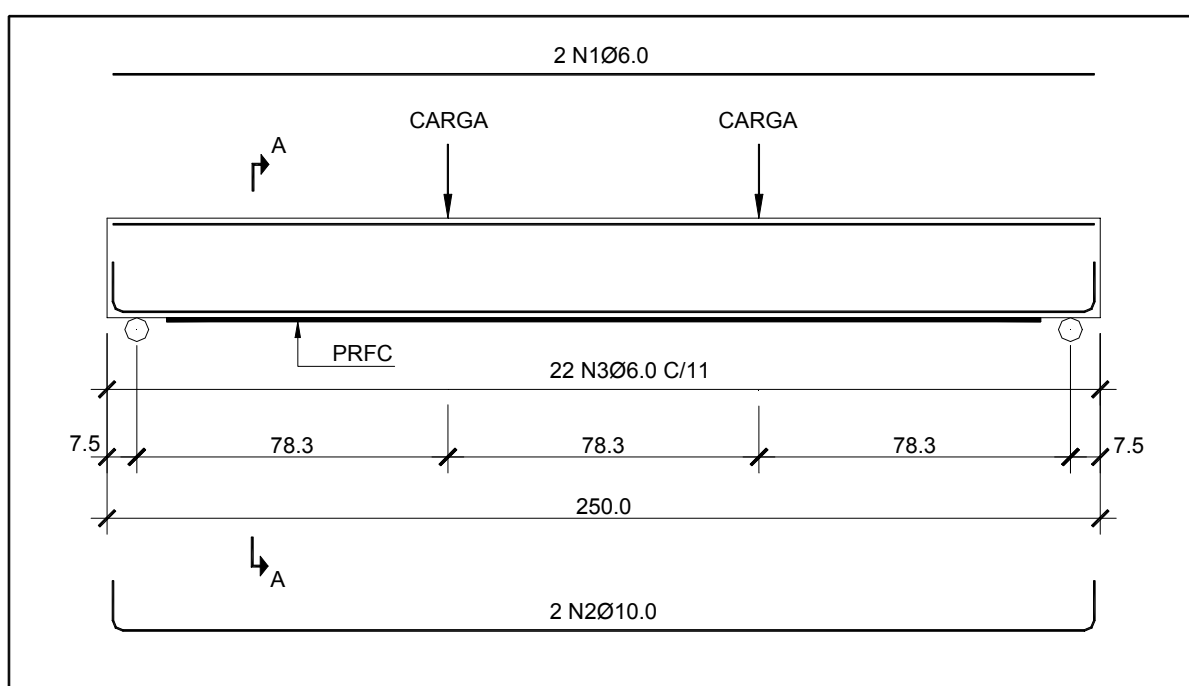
Dimensões e detalhamento das armações das vigas ensaiadas
